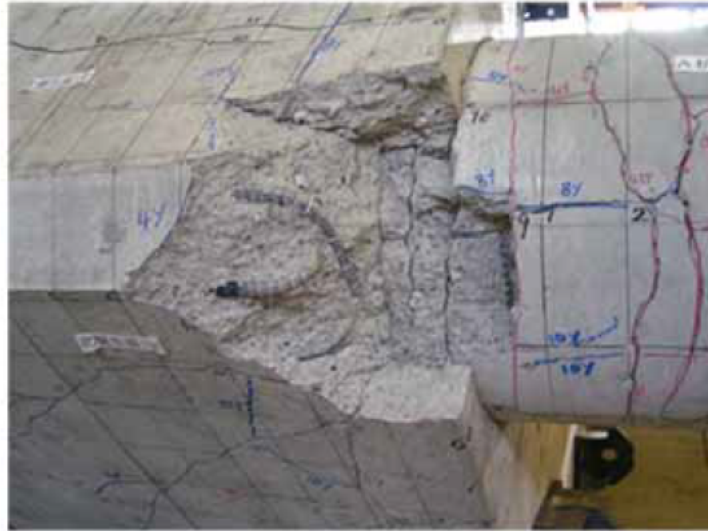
実験終了後 縁端部損傷状況 (Case CPP-C-1, Pile A)
